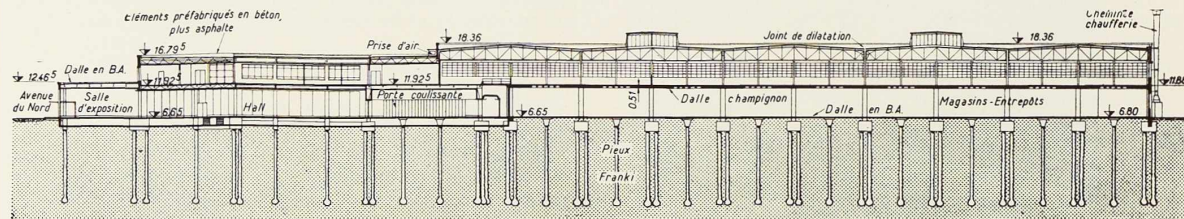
Coupe transversale au droit de la Salle d'exposition.
